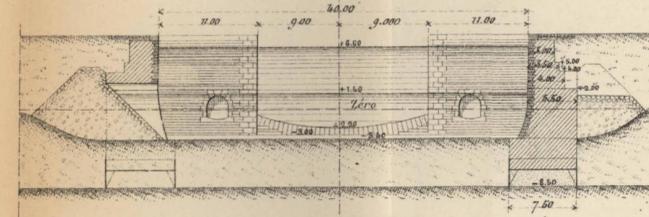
Elevation de la tête amont. Coupe suivant GH.
